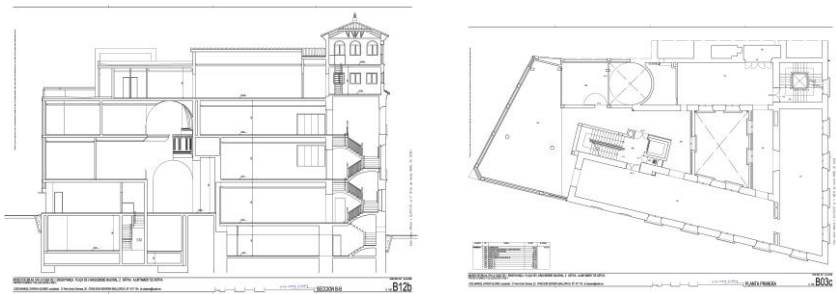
y 6. Plano de sección y de planta del proyecto museístico
